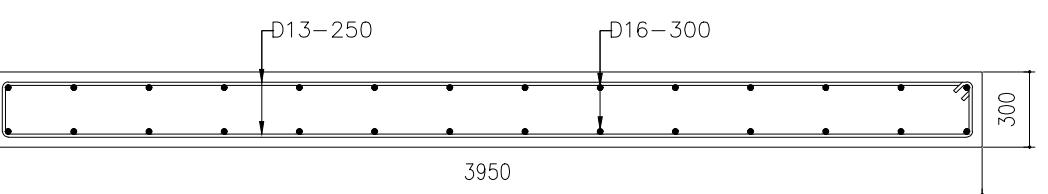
DETAIL SHEARWALL TYPE SW-1A LANTAI P1 S/D P7
